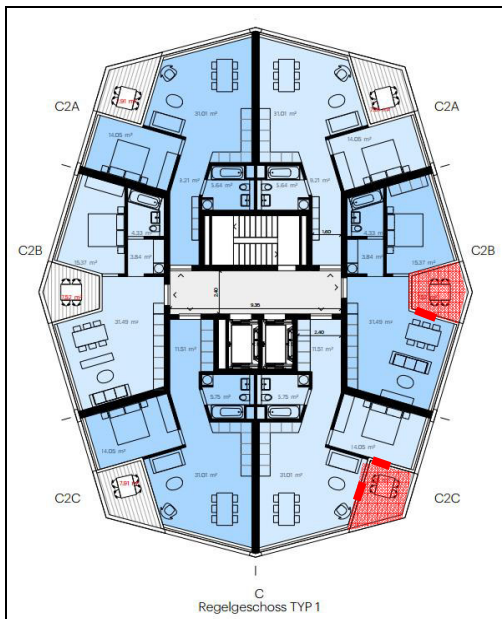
Haus C - Grundriss 1.OG bis 3.OG - Bereich Massnahmen aufgrund Strassenverkehrslärms
